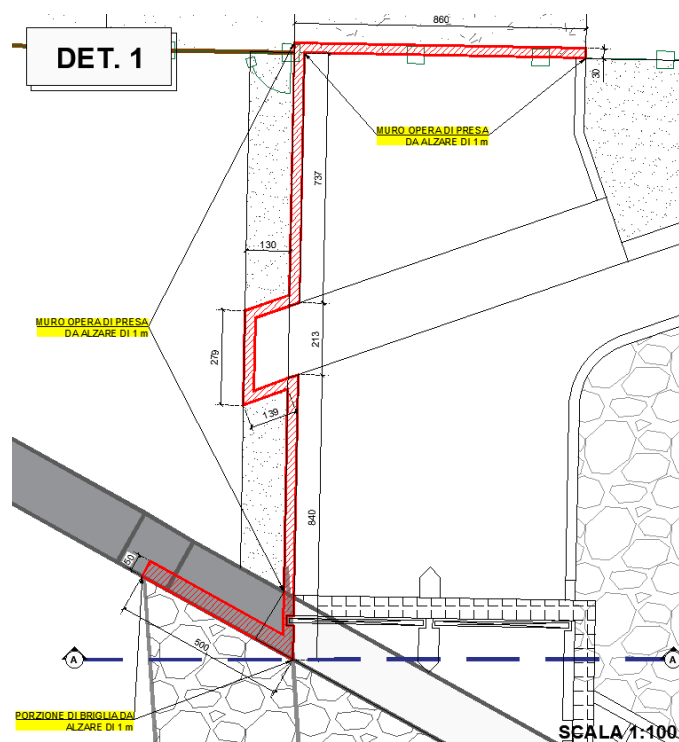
Pianta della porzione di briglia da innalzare e del muro dell'opera di presa
